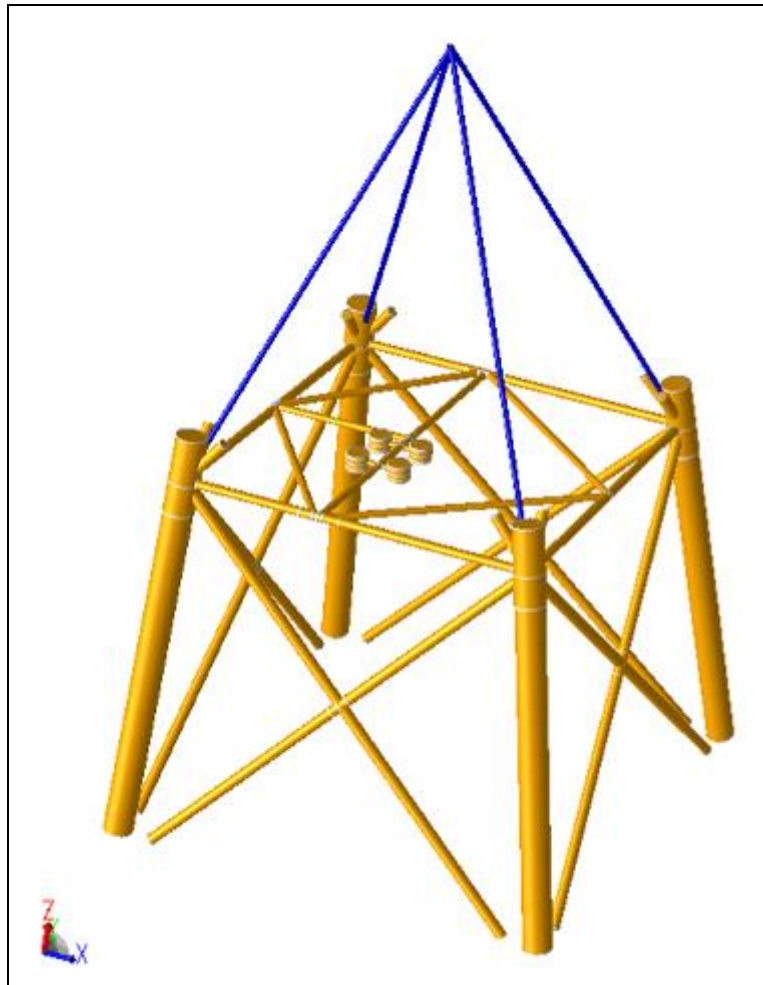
Seconda Sezione Jacket – Vista 3D
